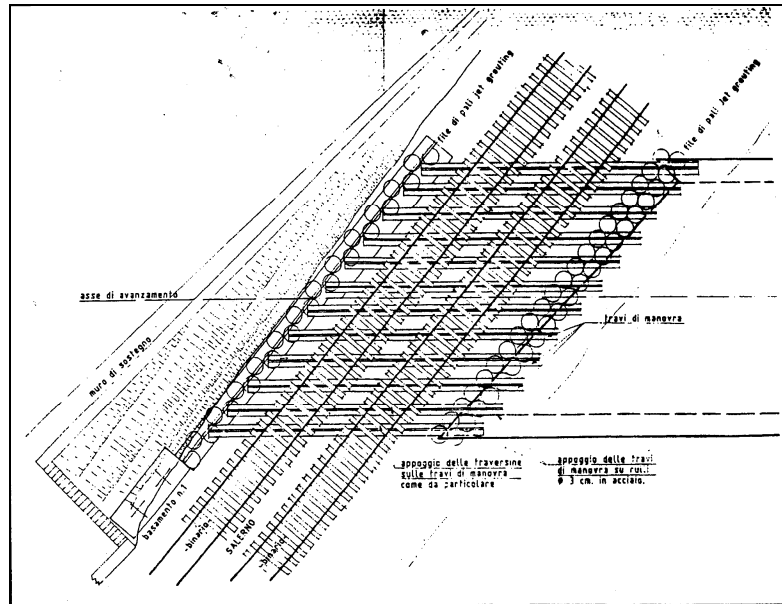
Pianta dei binari delle travi di manovra in assetto di varo
